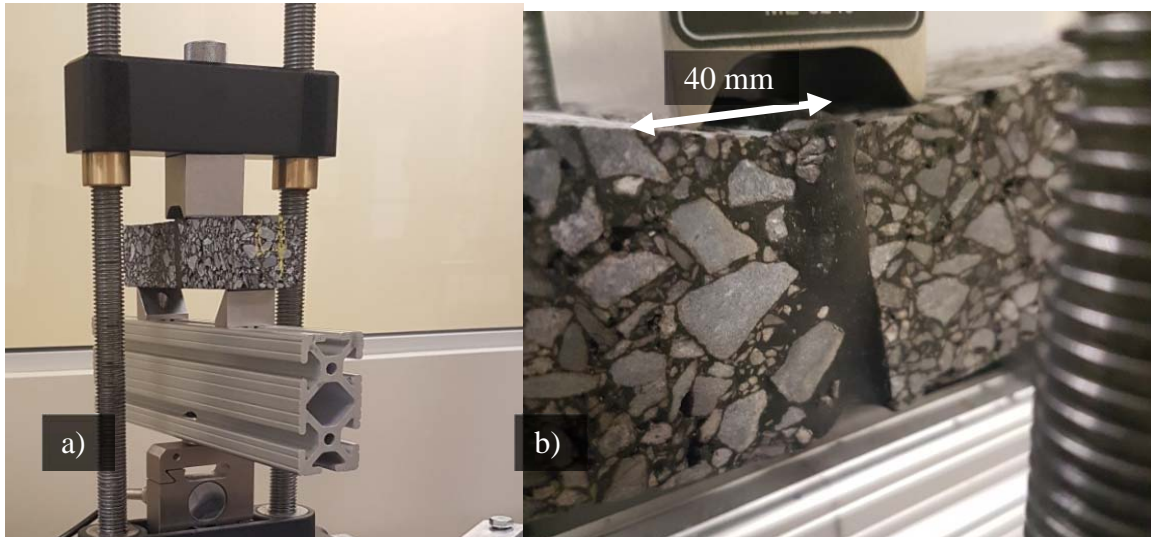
a) Vue globale du montage pour essai de flexion sur éprouvettes poutres et
